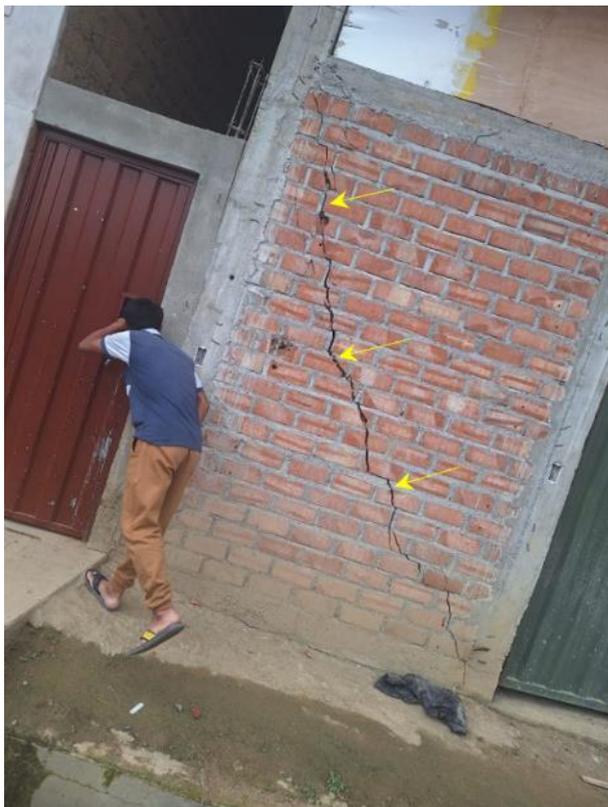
Vivienda afectada por agrietamientos en su fachada, longitud 2.5 m y 1.5 cm a 2 cm de ancho
